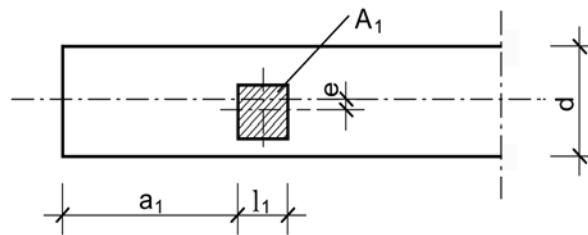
Geometriebedingungen des teilflächenbeanspruchten Mauerwerks aus DIN 1053-100:2007 [Gu. 13]
